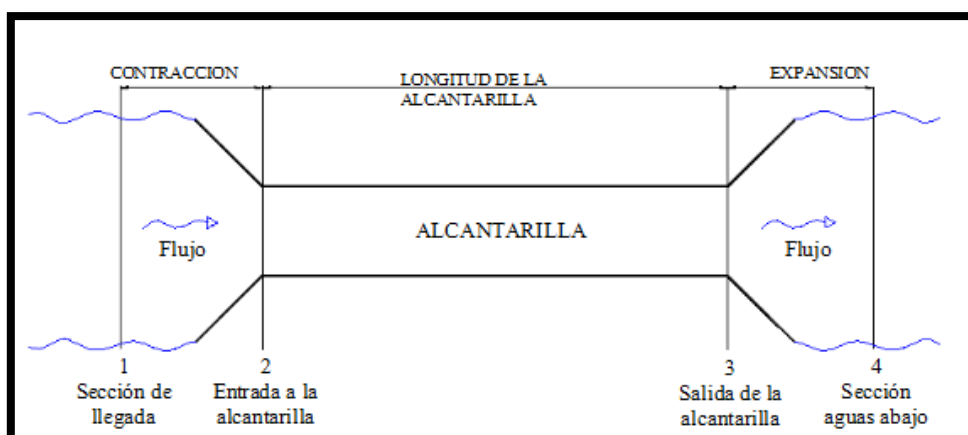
Vista en planta de una alcantarilla y secciones de control (Fuente: IMFIA & MTOP, 2000).
